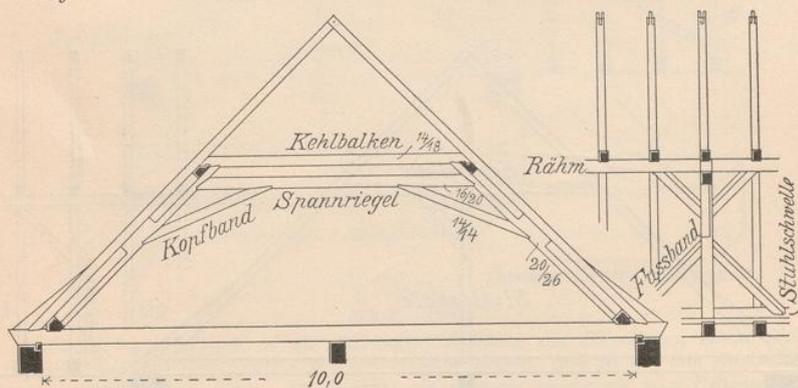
Dach. Kehlbalkendach mit liegendem Stuhle.
